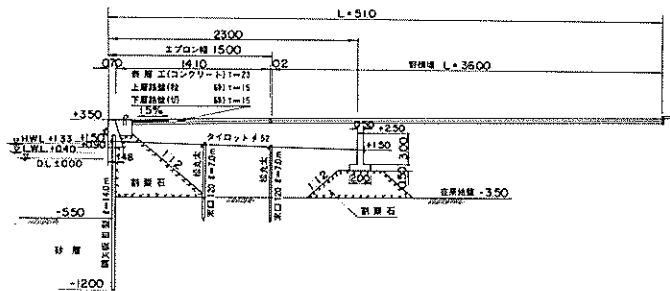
相馬港 -5.5 m 岸壁 (D断面) 標準断面図
